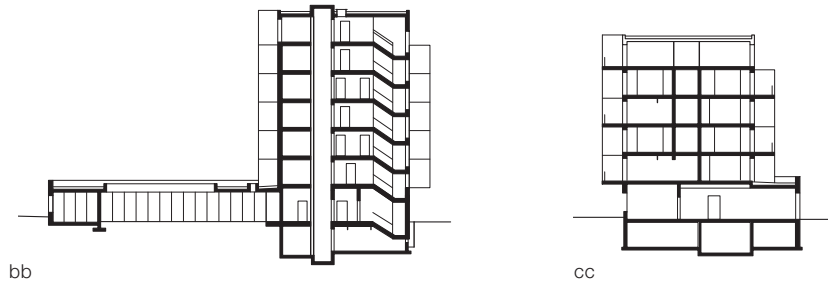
Schnitt und Grundrisse, Maßstab 1:750
